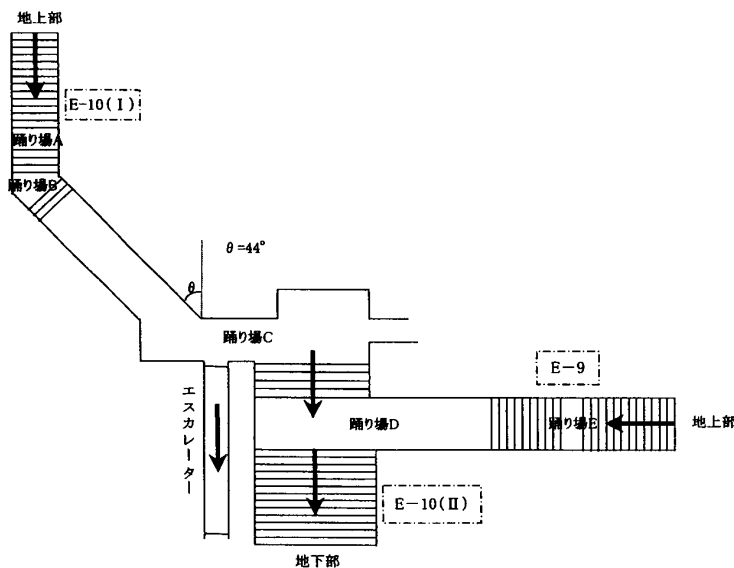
特殊形状を有する階段入口(E-9 + E-10)の平面図
